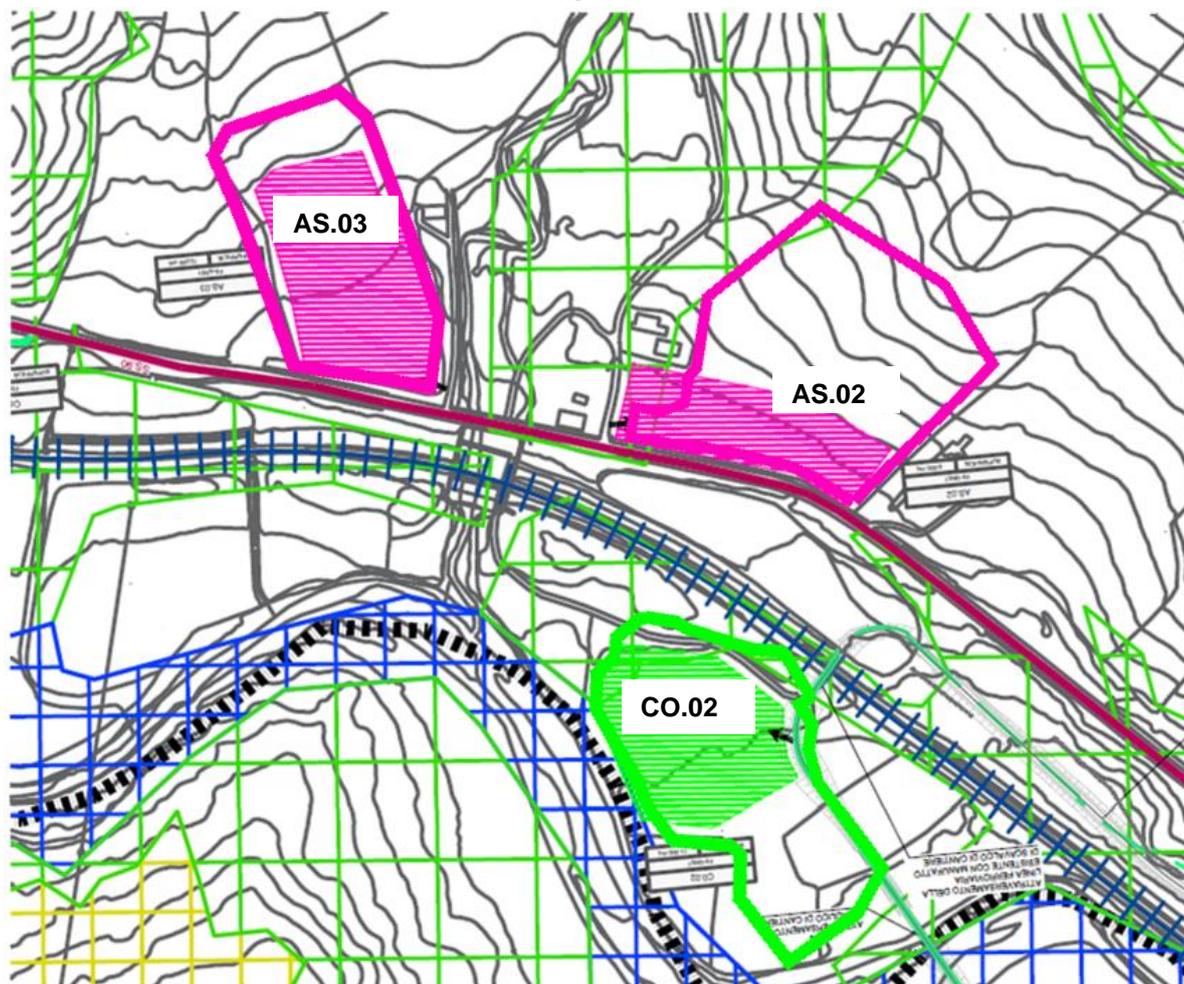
Ambito delle aree di cantiere a servizio della finestra F4 previste dal Progetto Definitivo poi eliminate con il Progetto Esecutivo
